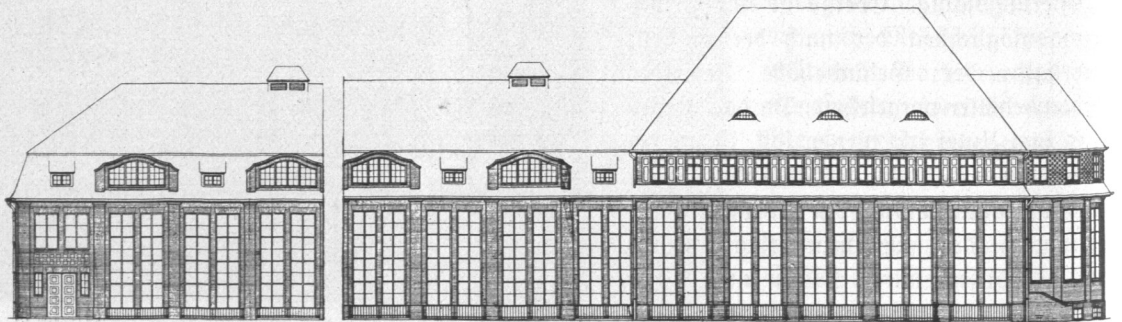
Technische Staatslehranstalten, Straßenansicht des Maschinenlaboratoriums.
